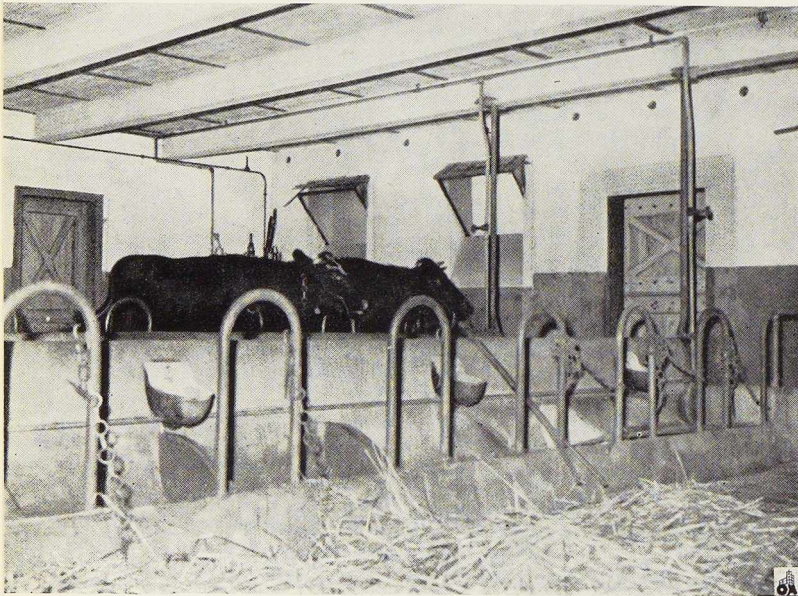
Installation d'étables avec arceaux en tubes d'acier.
